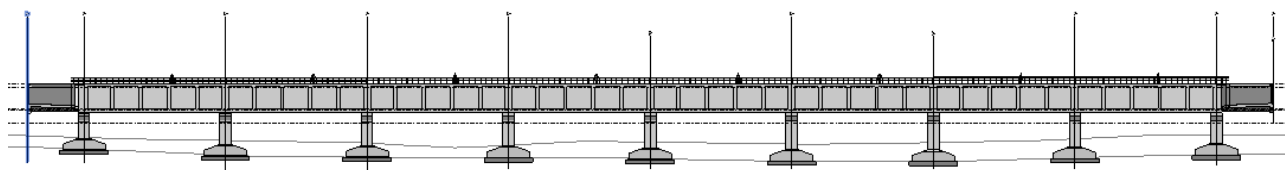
Vista lateral do Aqueduto Xingozinho
